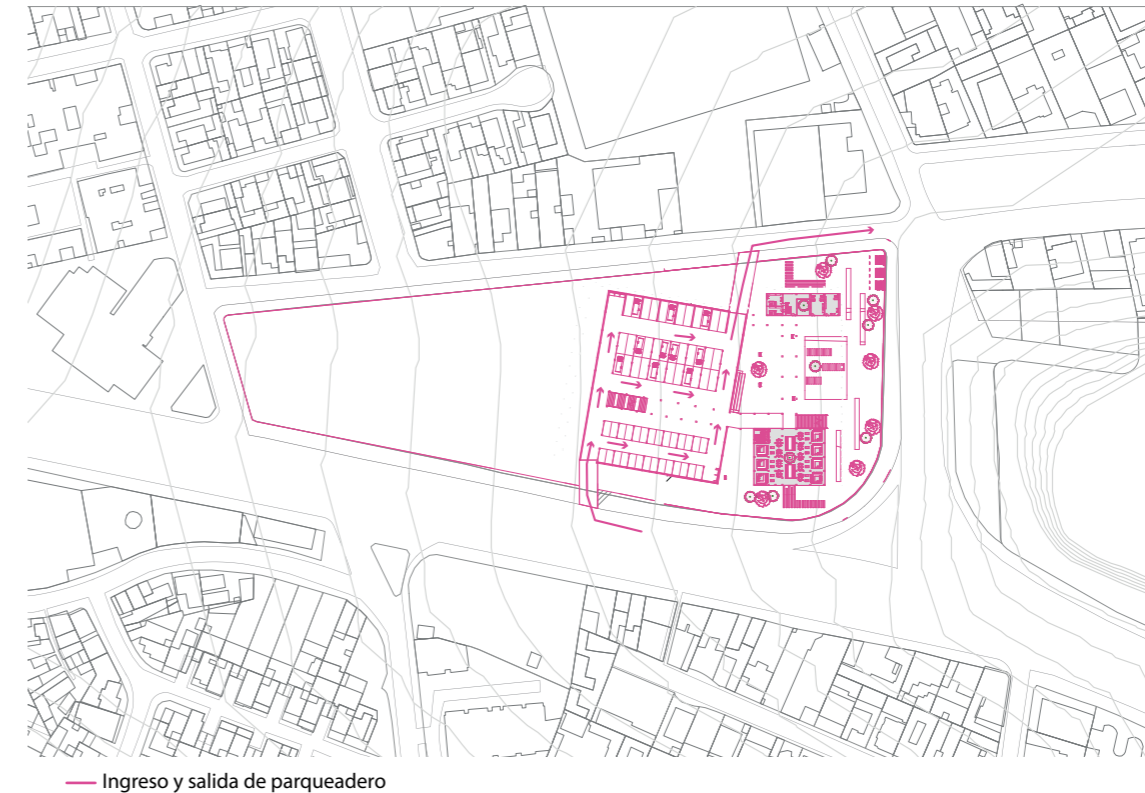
Diagrama de accesos al parqueadero. Elaboración propia.(2025)
